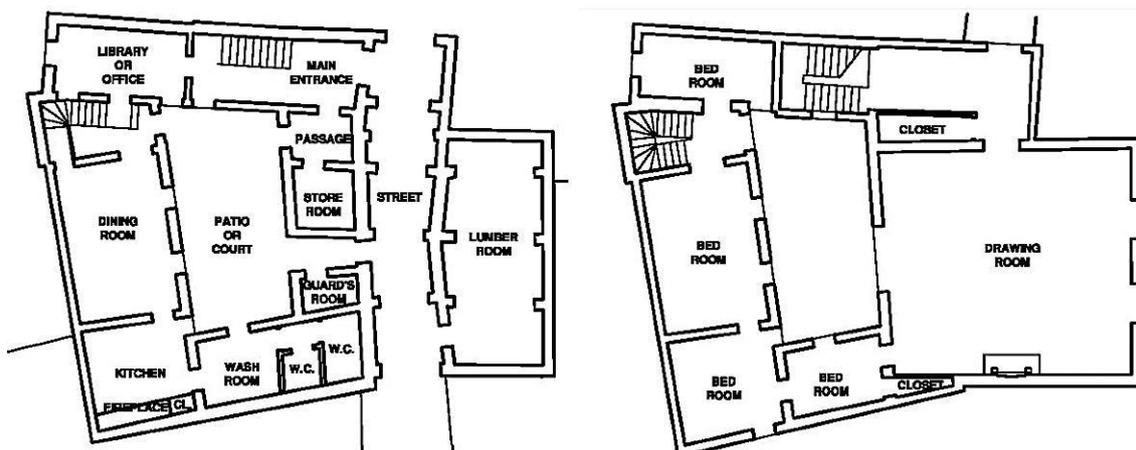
Planta baja (izquierda) y primer piso (derecha) tras la restauración de 1848 (II. Architectural 2010)
